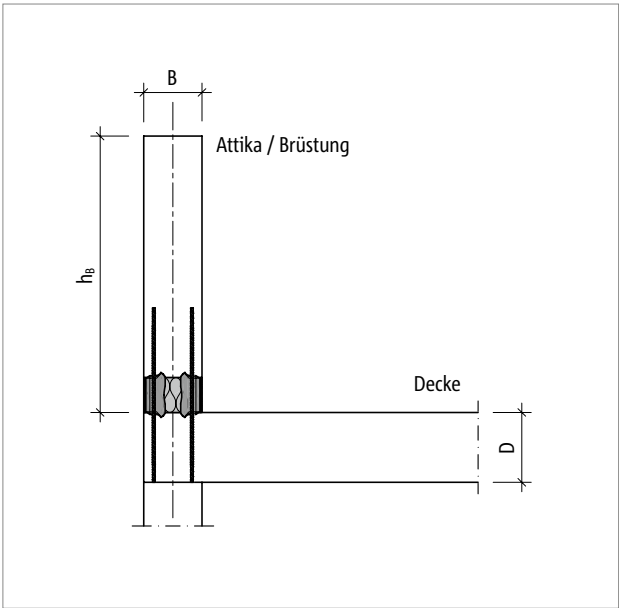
Schöck Isokorb® CXT Typ A: Statisches System
